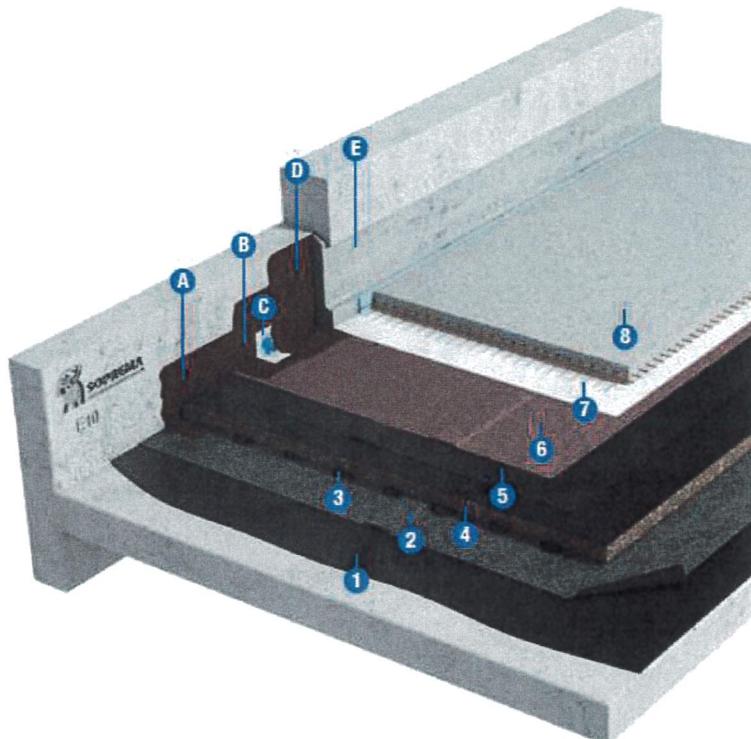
Cas d'une toiture terrasse parking véhicules légers avec isolant XPS et protection dallage en béton armé cf. NF DTU 43.1
